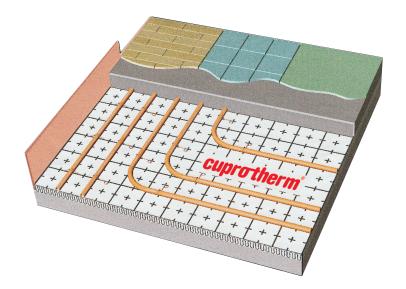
Панельное отопление CUPROTHERM®: укладка труб в мокрой стяжке
